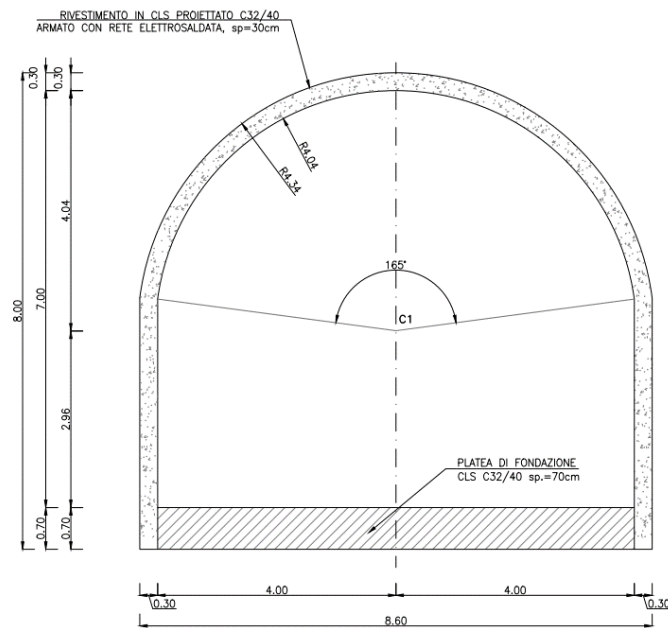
Sezione tipo GA 1 della galleria di accesso alla centrale
